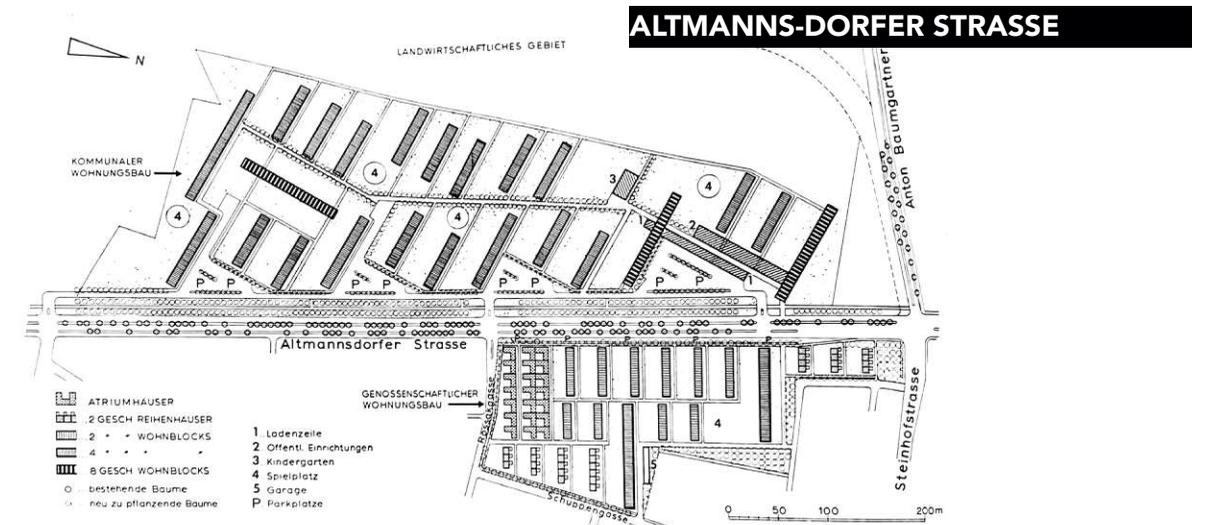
Wohnanlage Altmannsdorfer Straße-Baumgartner Straße, Wien 23. Bezirk
